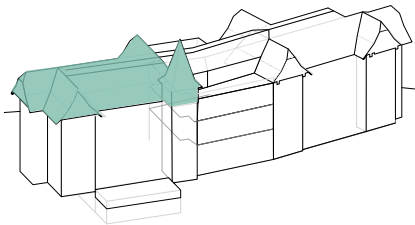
| Grundriss Abbruch/Neubau O2
